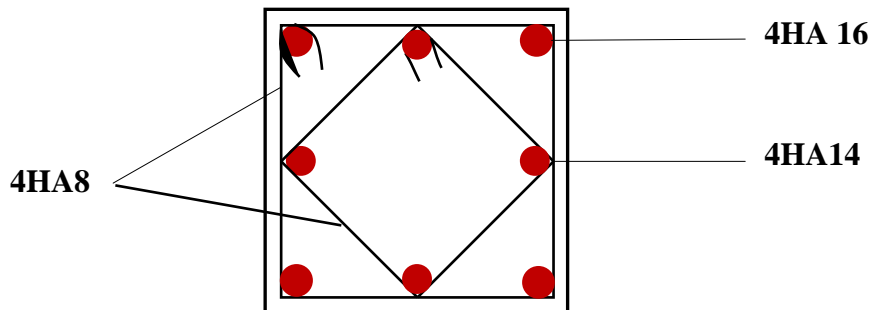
Schéma de ferraillage du poteau 40x40
